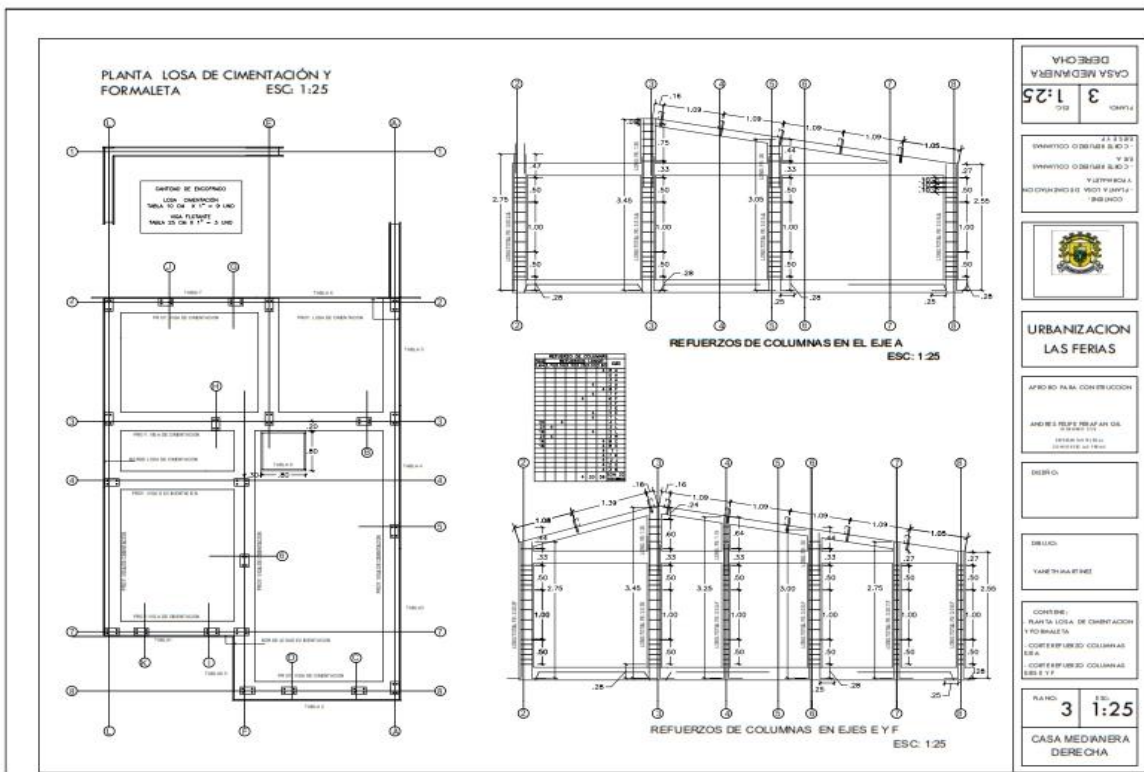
Planta losa de cimentación, refuerzo columnas eje A, E, F.
